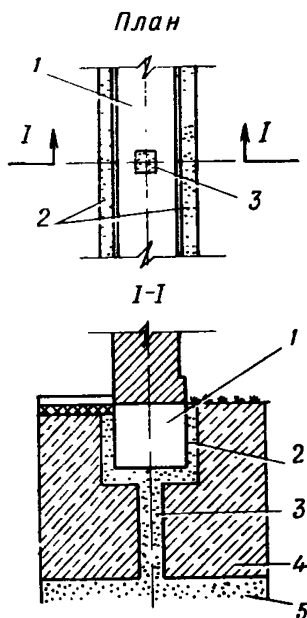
Фундамент с дренажными обсыпками и колодцами
